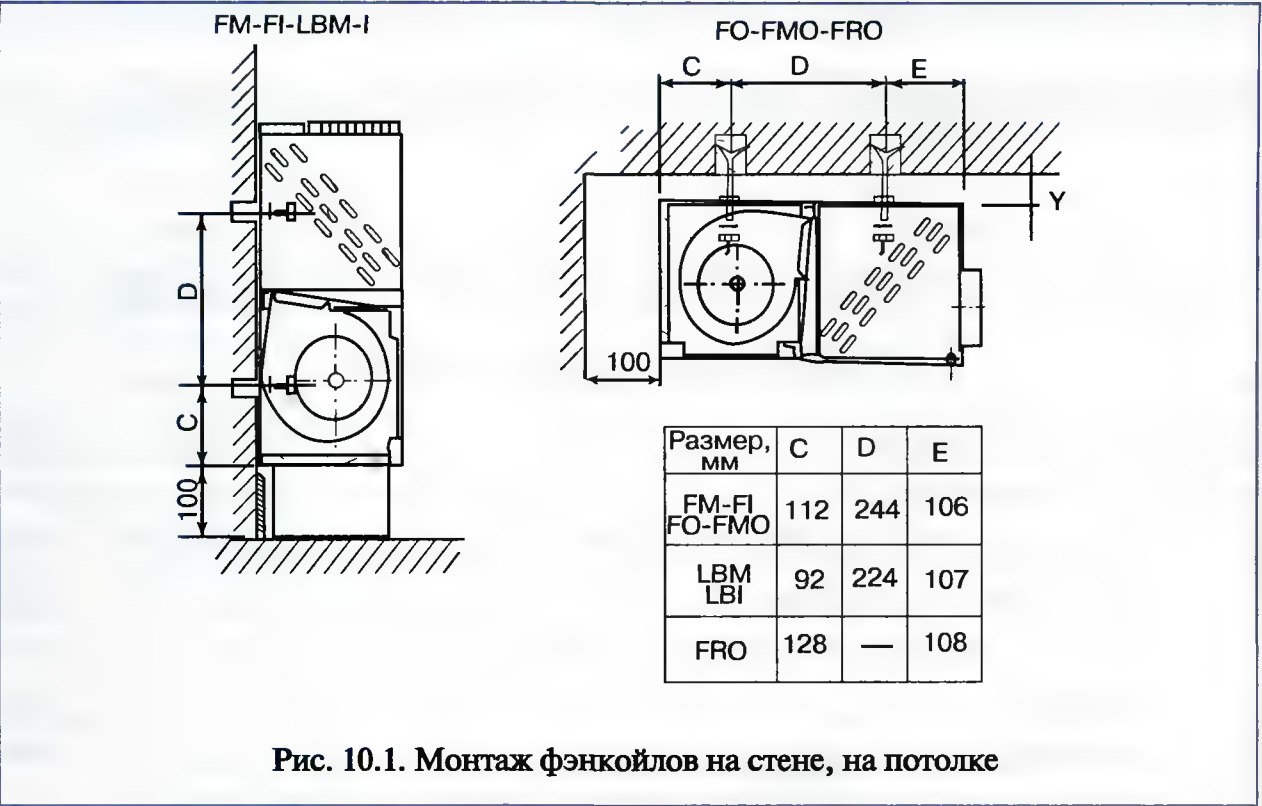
Монтаж фэнкойлов на стене, на потолке
